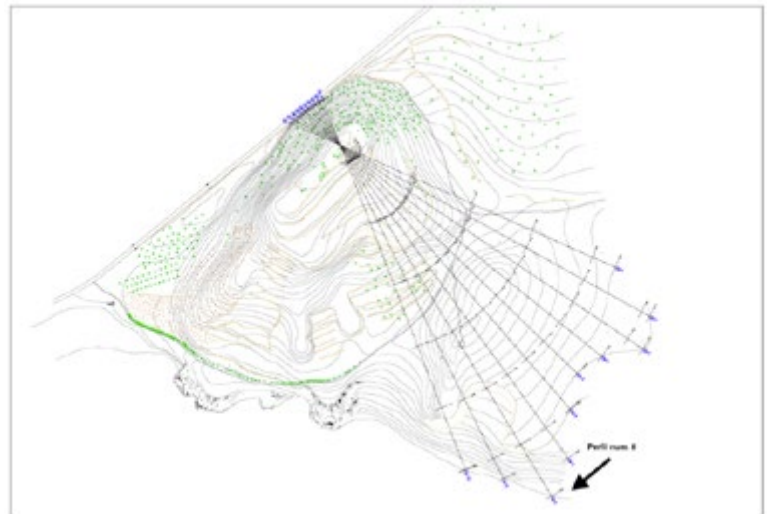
Planta perfiles proyectados sobre la elevación SE frente al Tossal de Manises. Astil. ATM.
